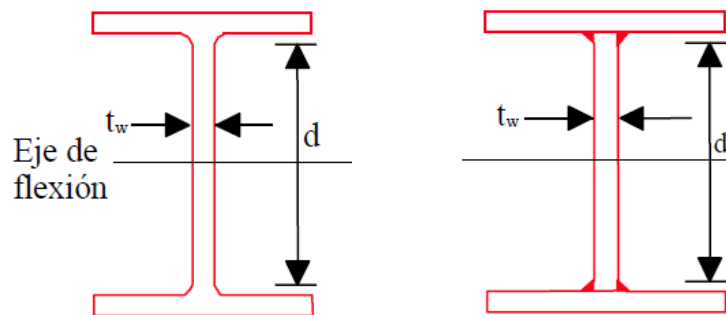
Secciones I Laminada (izq.) y Soldada (der.).
